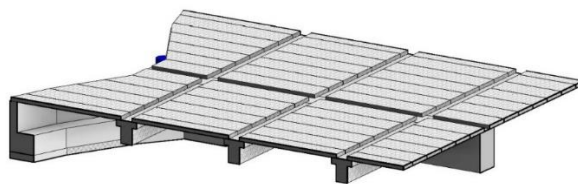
Vista 3D do apoio das pré-lajes da cobertura do reservatório.
